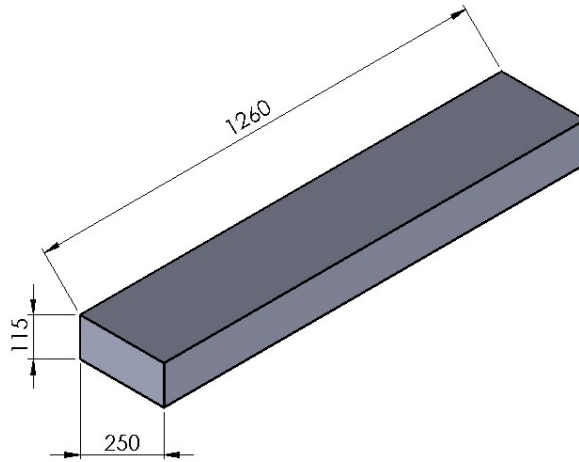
Aproximación de la geometría de la viga horizontal en mm (Fuente: propia)
